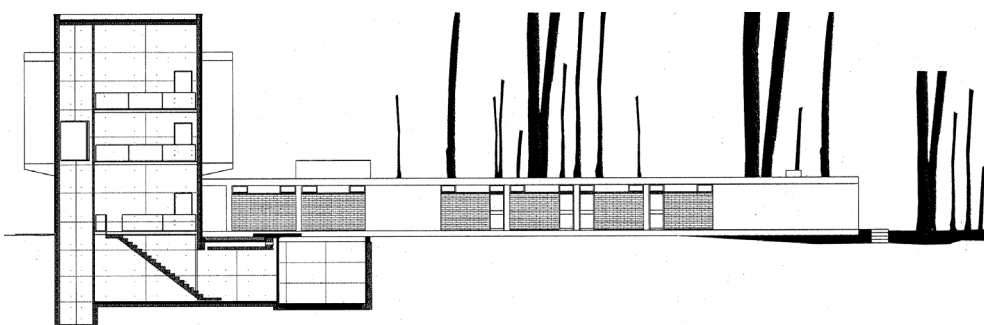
Corte transversal à nova torre do elevador - Primeira proposta de intervenção.
